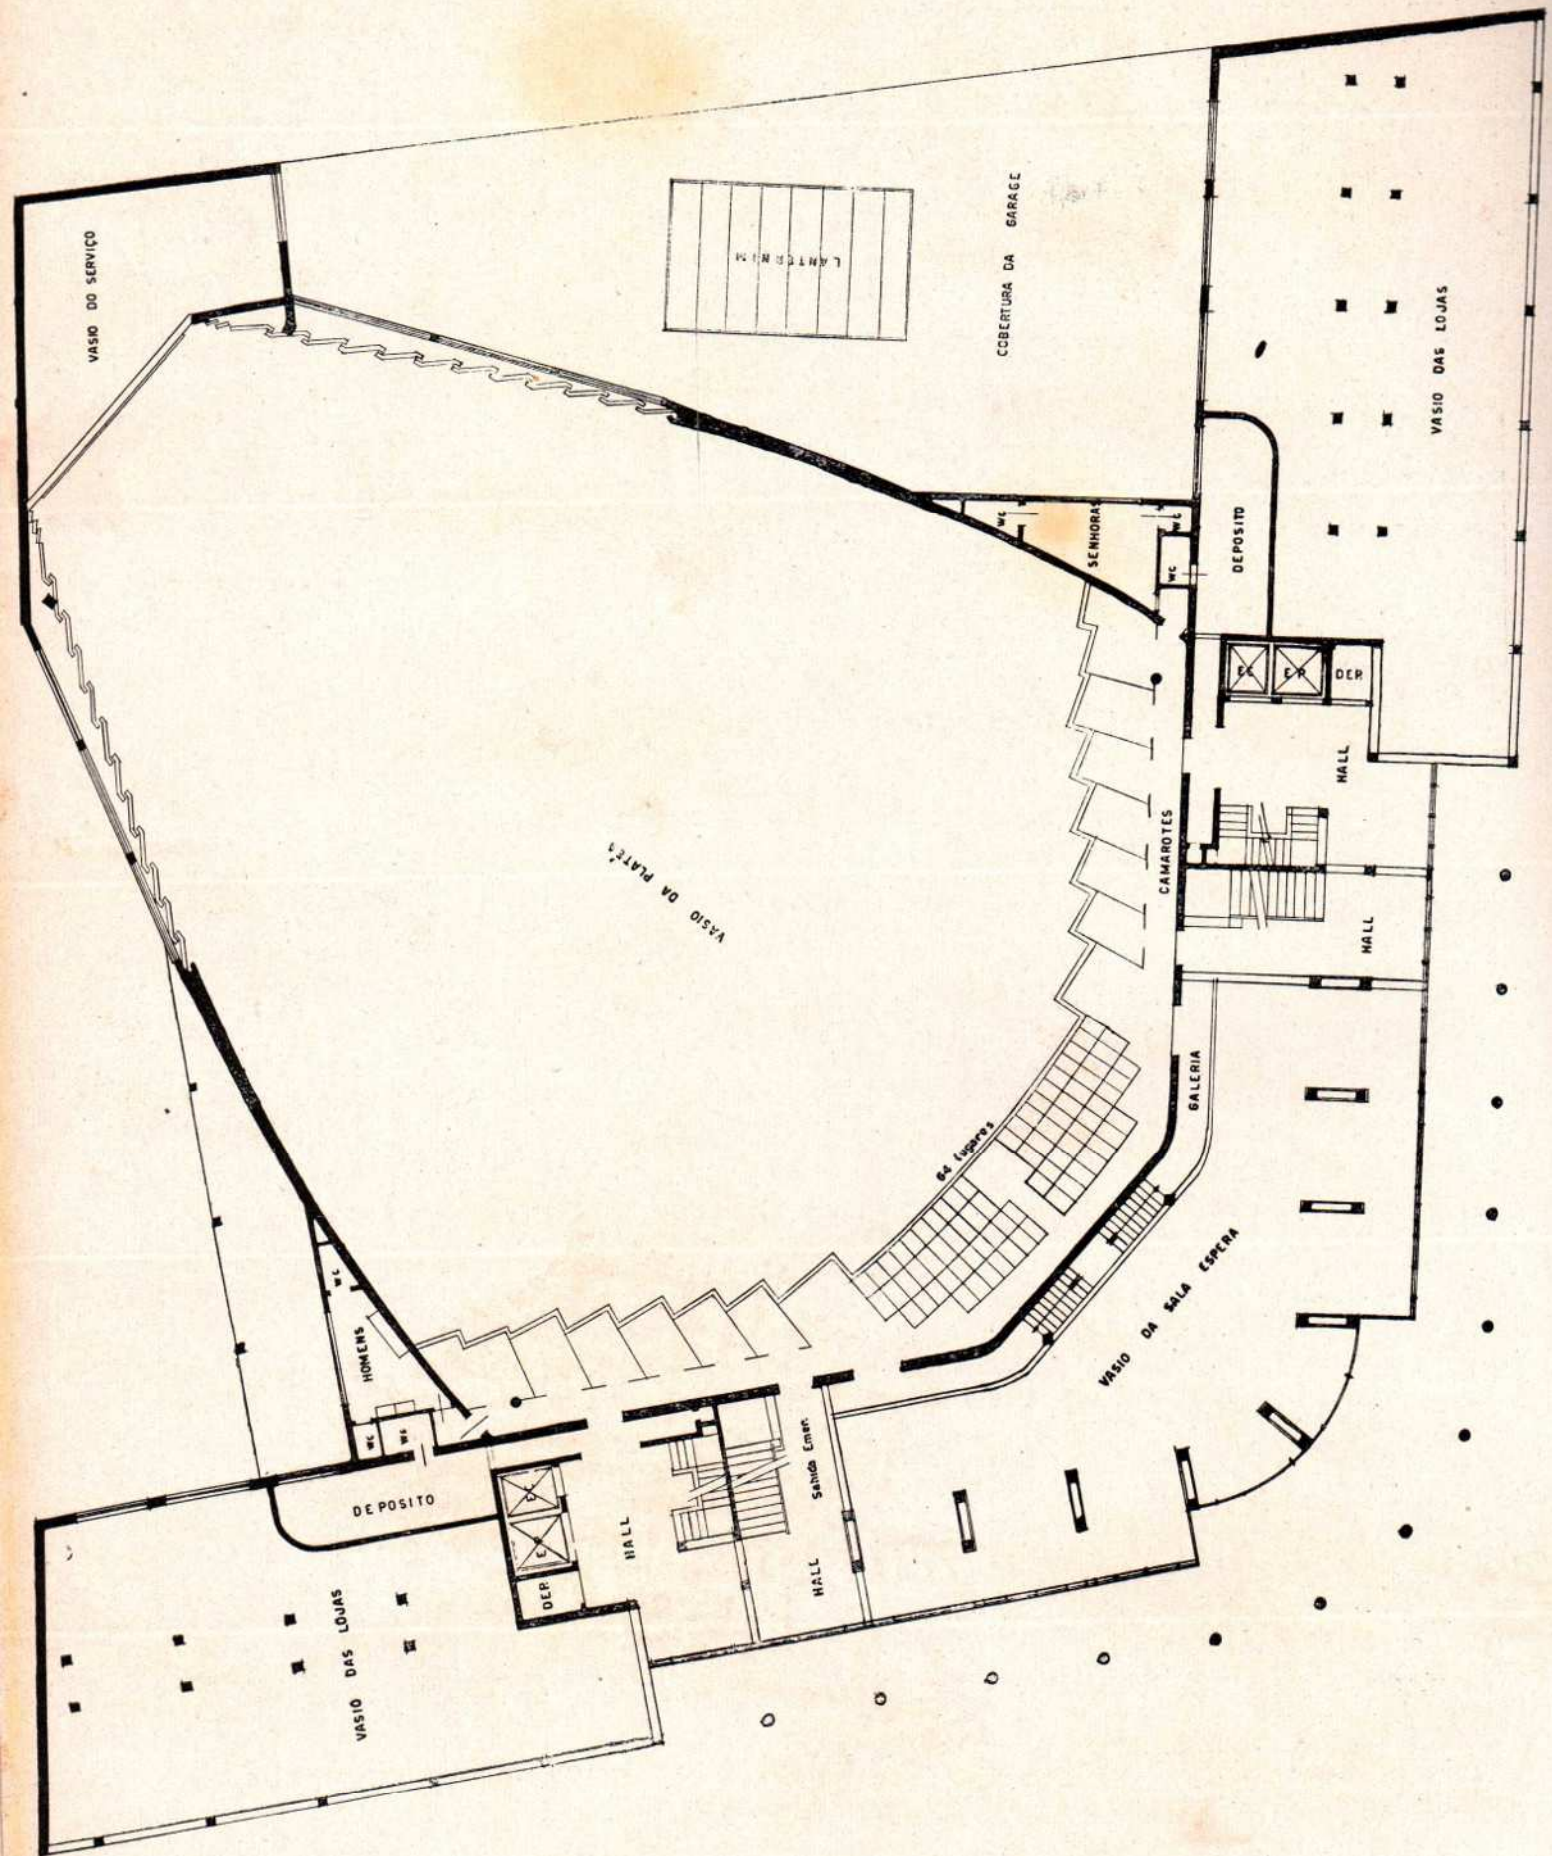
Edifício Roxy — Planta da sobre-loja.
